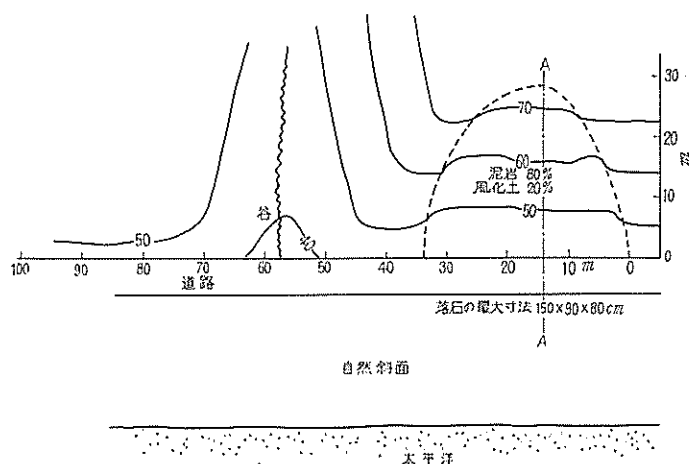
おせんころがし道路切土のり面の崩壊平面図
